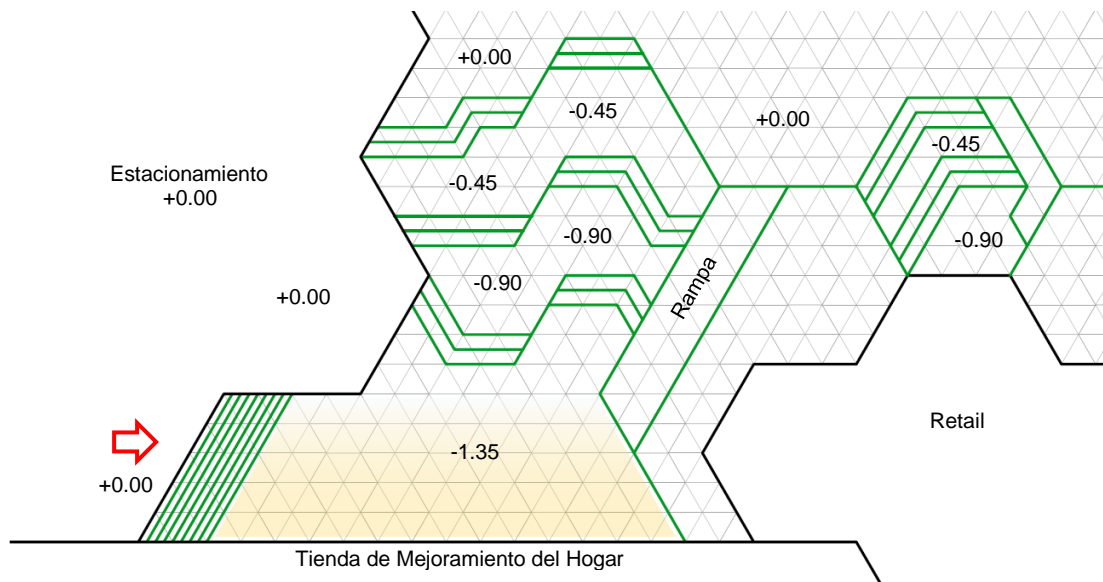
Sector 2, Desarrollo de Rampas y Escaleras
